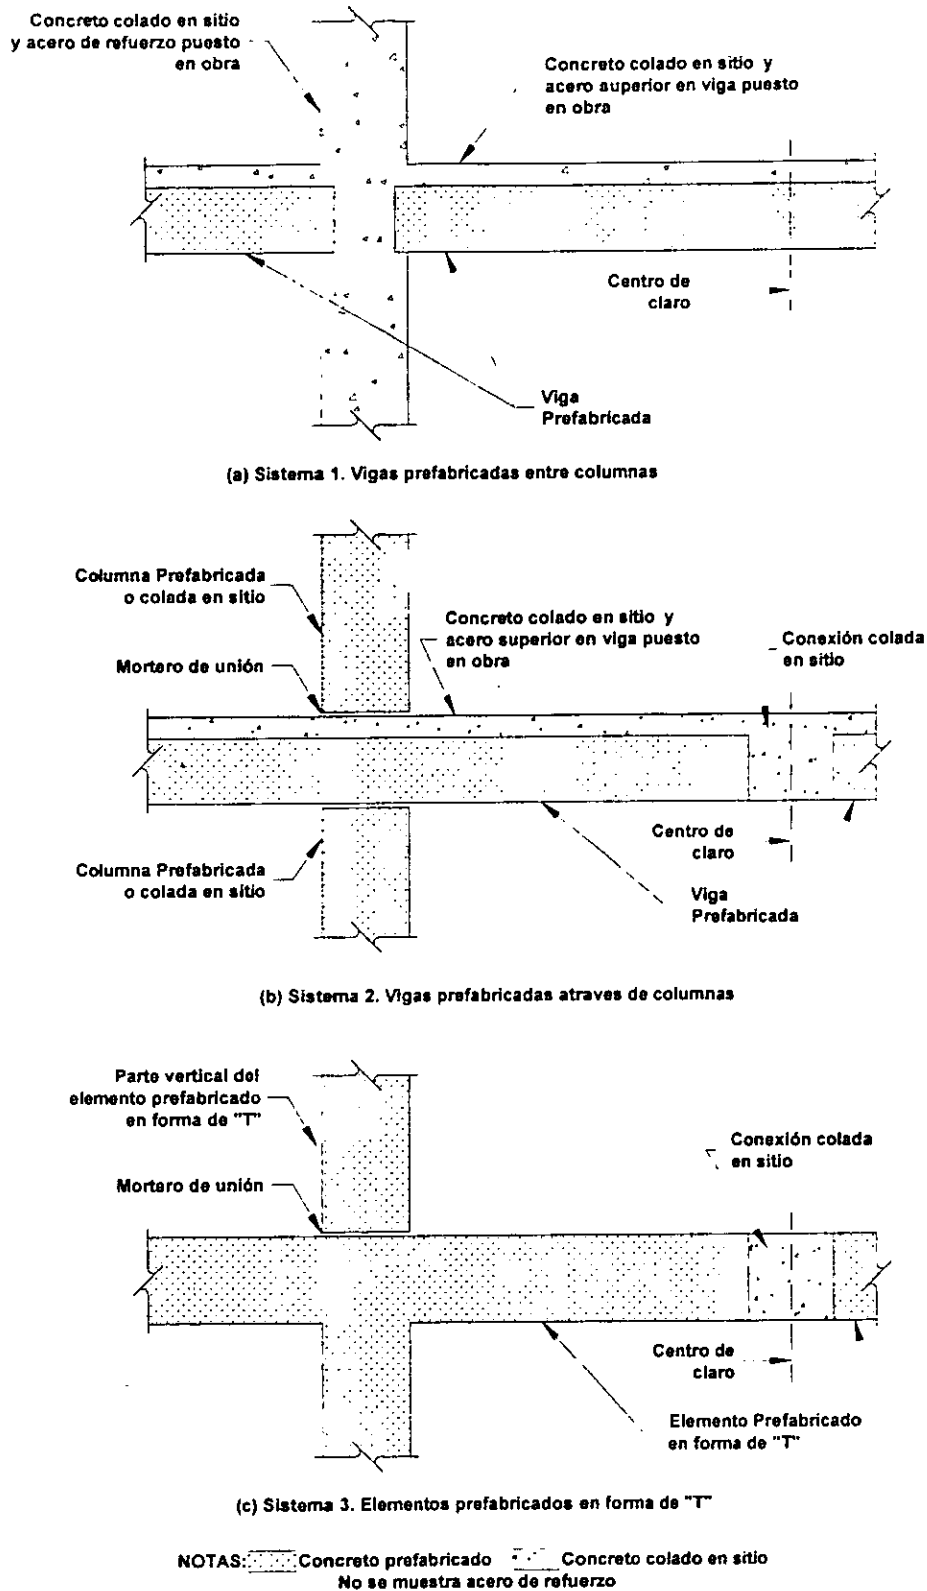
Configuración para conexiones de elementos prefabricados y colados en sitio
